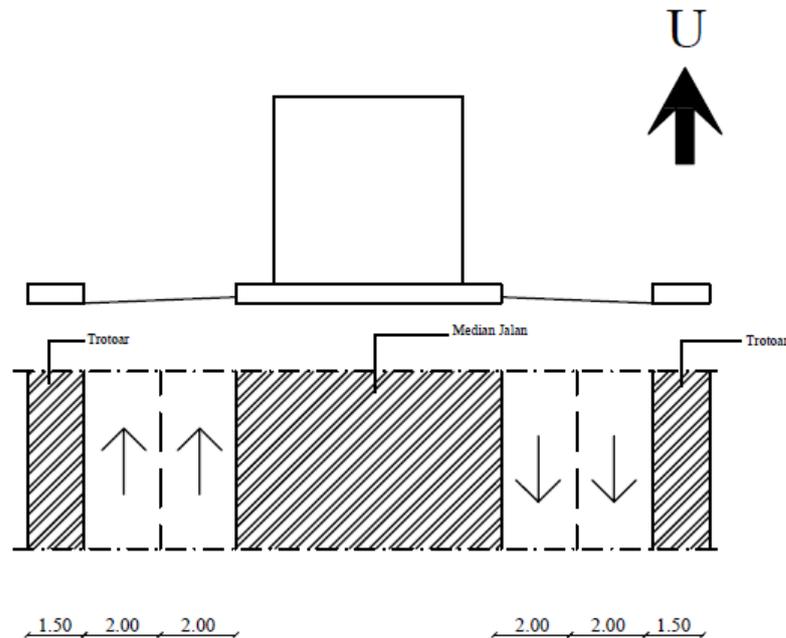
Tampak Atas dan Potongan Melintang Detail Geometri Ruas Jalan Tukangan
